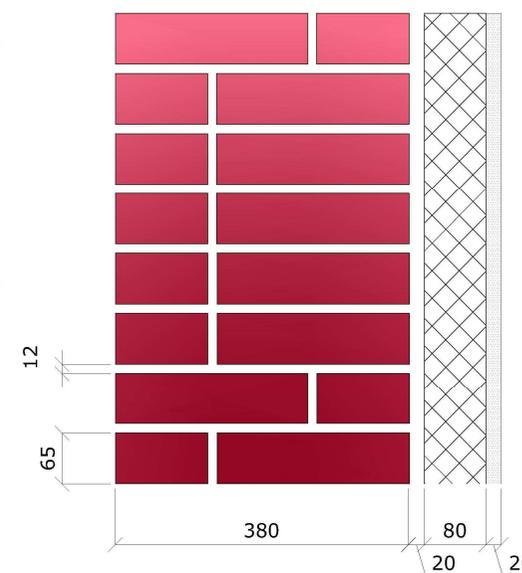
Конструкция стены одинарный полнотельный рядовой кирпич с наружным утеплением
